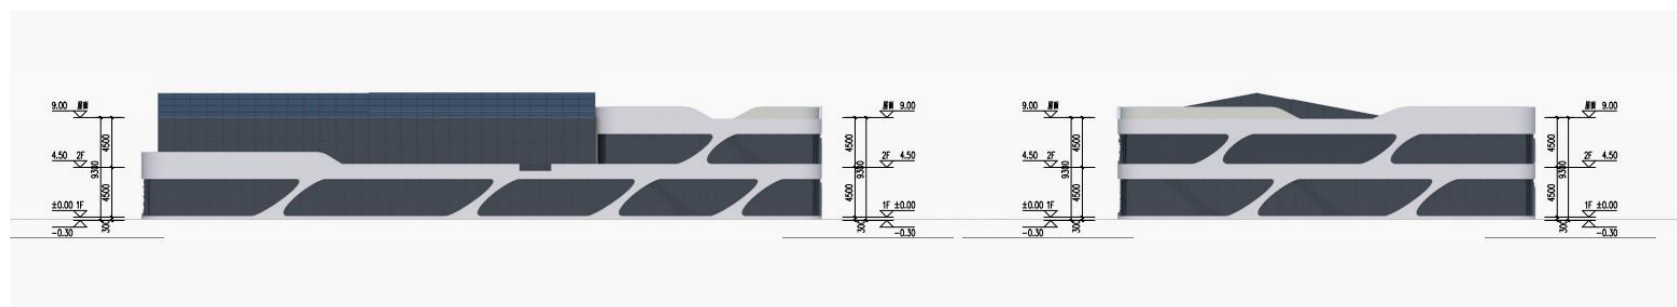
汕头农作物品种繁育研发基地西南立面图（左）及现代设施农业展示基地东南立面图（右）
